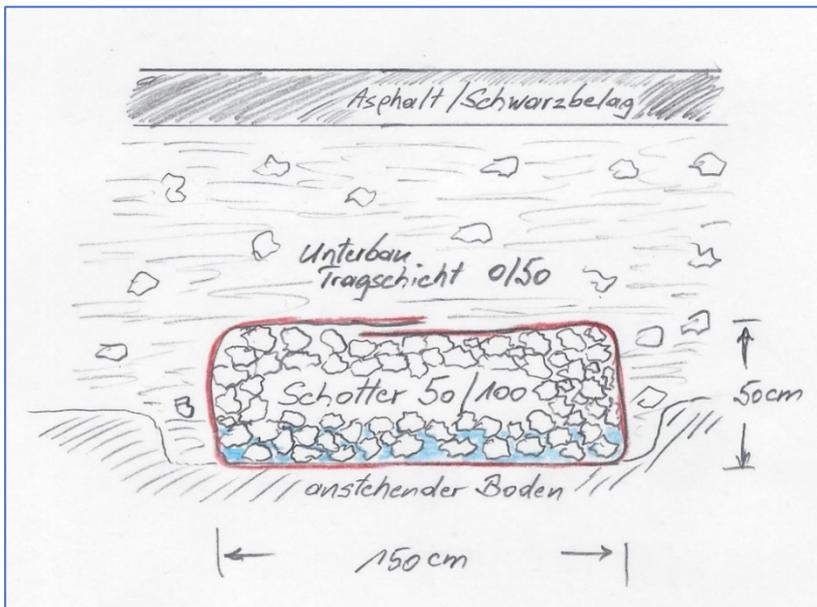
Skizze einer Sickerrolle mit einem Querschnitt von 50x150 cm – eingebaut in die Fahrbahn (Ä. Erpelding)
